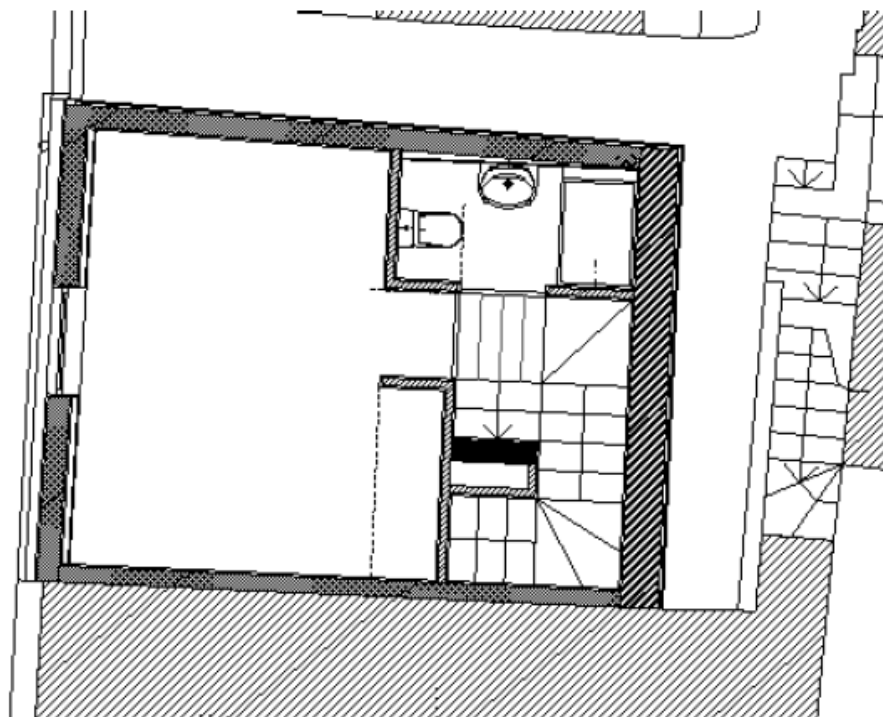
Planta do edifício Cedofeita: Piso 1
